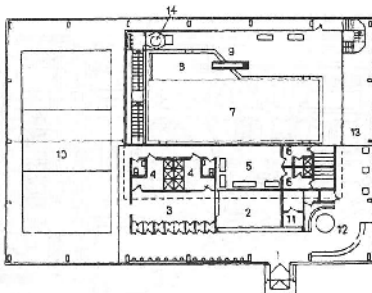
Физкультурно – оздоровительный комплекс комплексной поставки (арх. И. Гунет, инж. Б. Беленький). Совмещенный план 1 и 2 – эляжей: 1 – вестибюль; 2 – гардероб; 3 – раздевальная с проходными кабинками; 4 – душевая; 5 – помещение тренажеров; 6 – сауны; 7 – ванна 16,67×6 м; 8 – малая часть залы для обучения детей; 9 – тобоган; 10 – спортзал 24×12 м; 11 – администрация; 12 – чайная; 13 – универсальное помещение; 14 – фильтры
